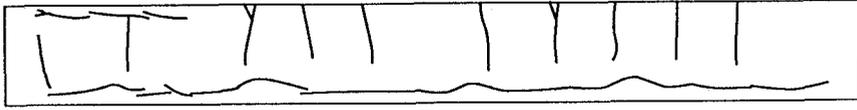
ひび割れパターンの一例（H3の側面1）
